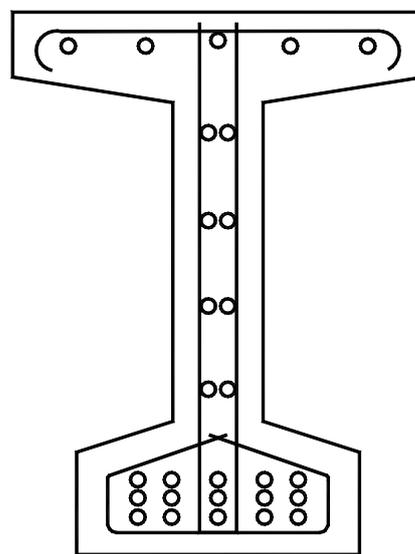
Поперечное сечение и армирование двускатной двутавровой балки
